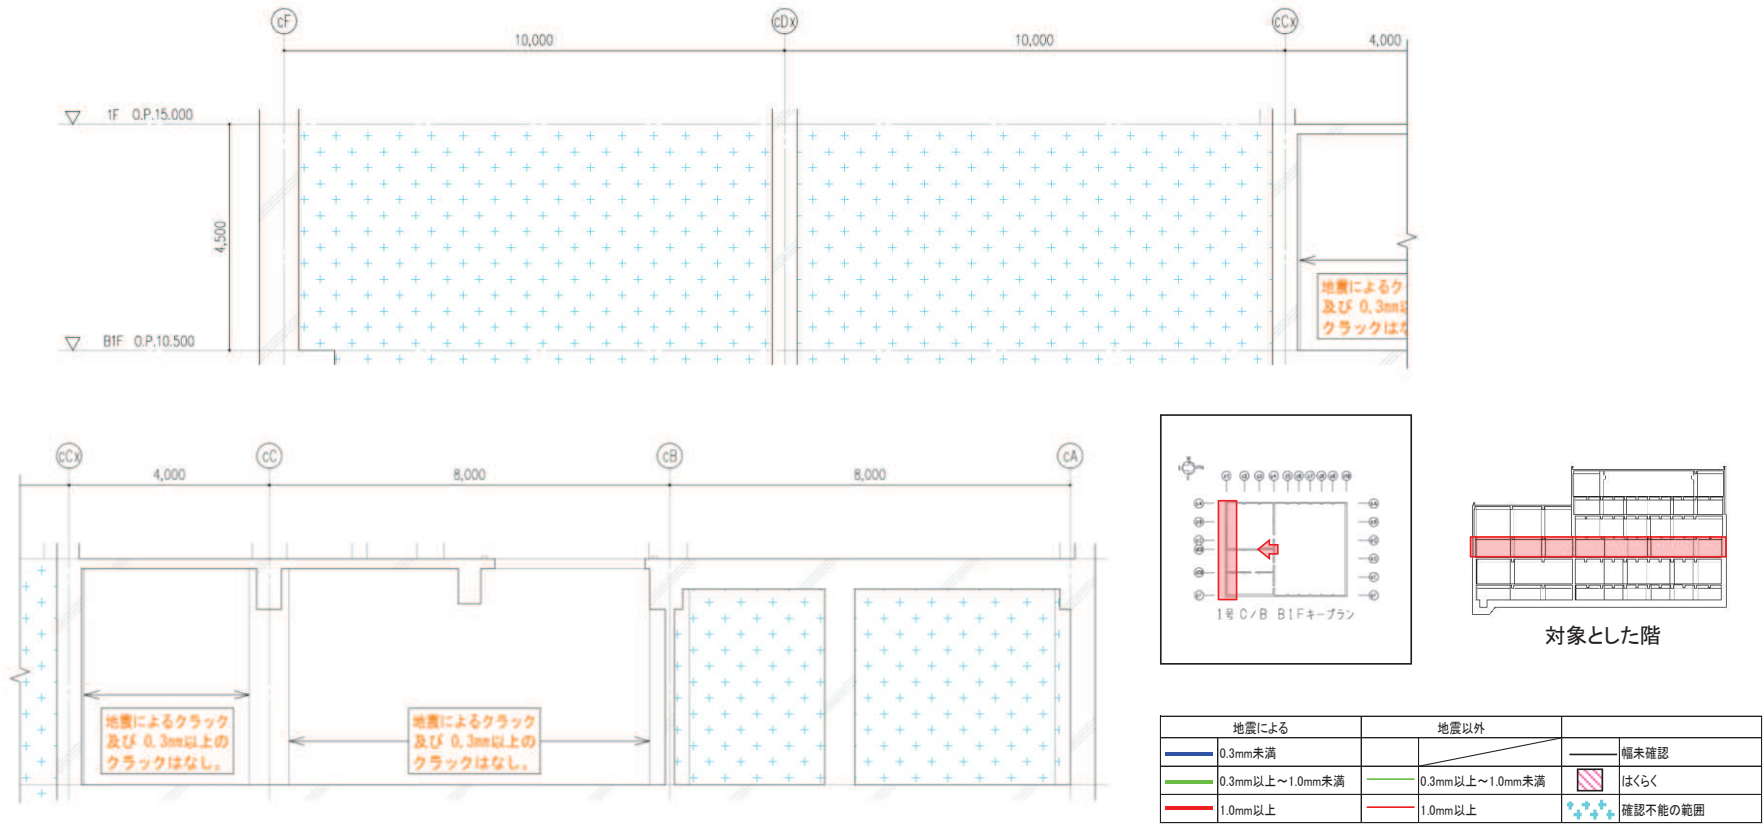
第 1 号機制御建屋のひび割れ分布 耐震壁 (14) 地下 1 階 C1 通り
